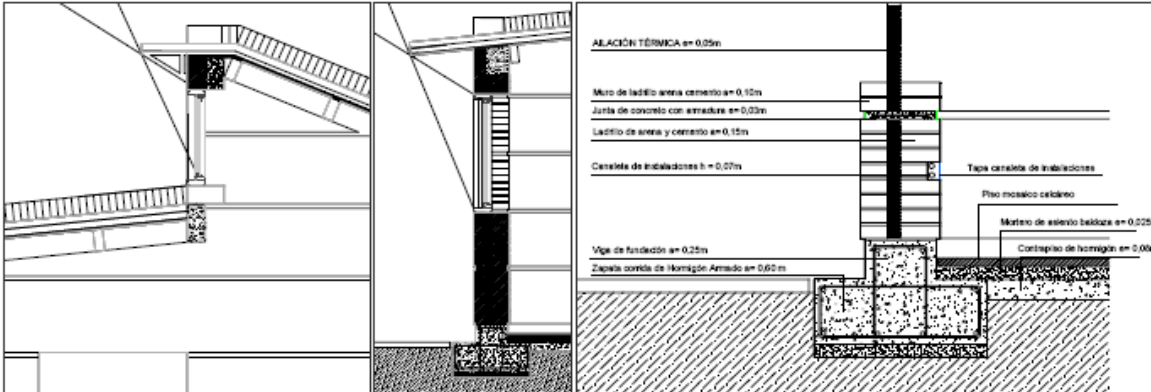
Detalle constructivo de la vivienda rural bioclimática. Mitchell (2000). J. Diseño De Un Asentamiento Humano.
